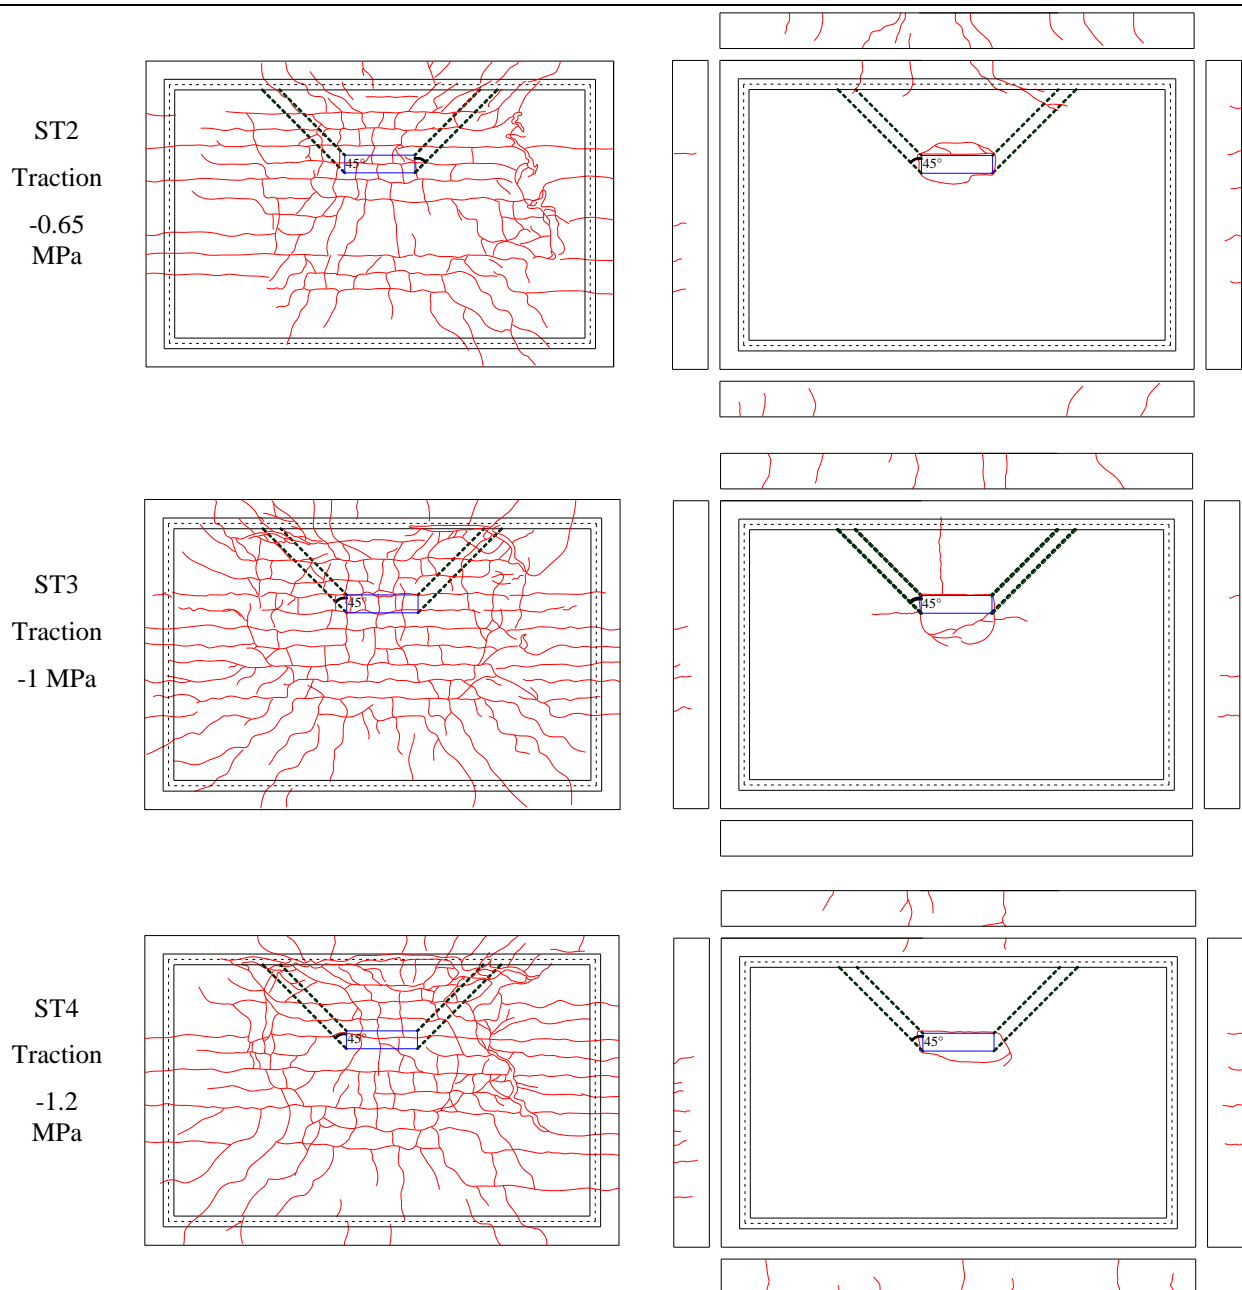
Schémas de fissuration des dalles de la série VII et VIII
